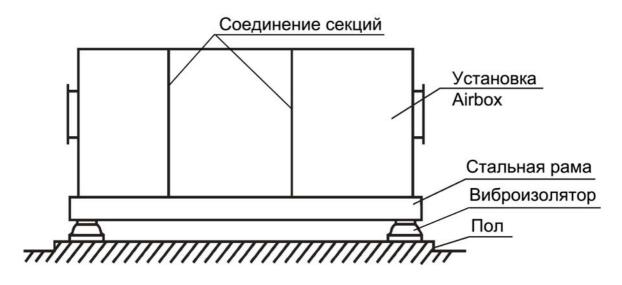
Размещение установки на стальной раме с виброизоляторами
